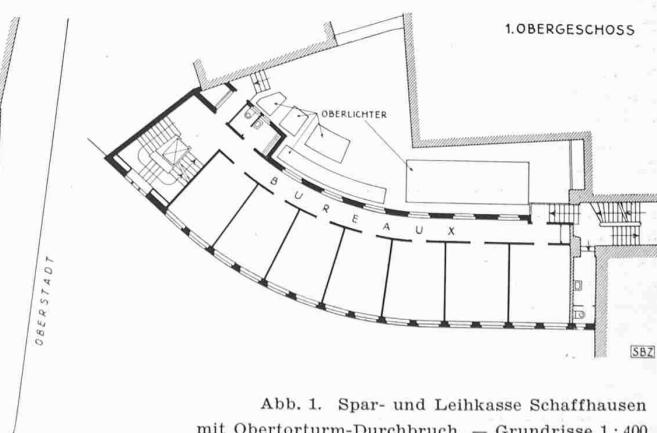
Spar- und Leihkasse Schaffhausen mit Obertorturm-Durchbruch. — Grundrisse 1:400
